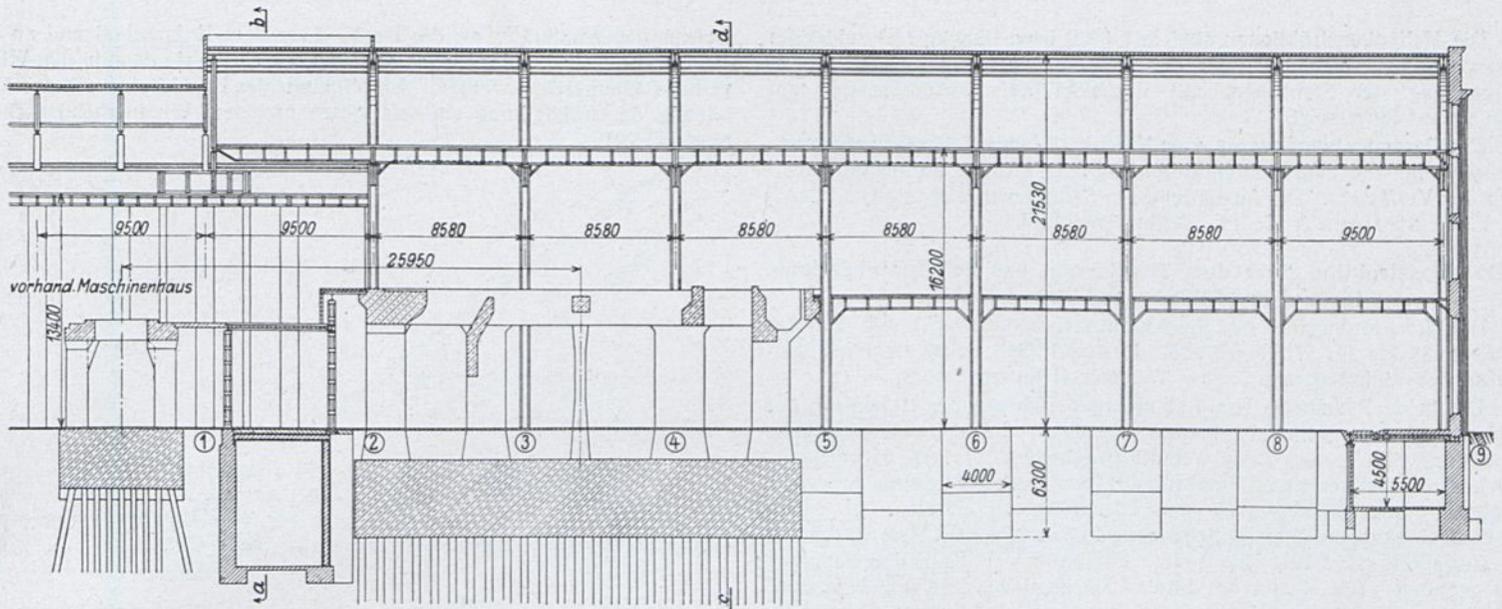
Kraftstation Wilmersdorf. Längsschnitt.
